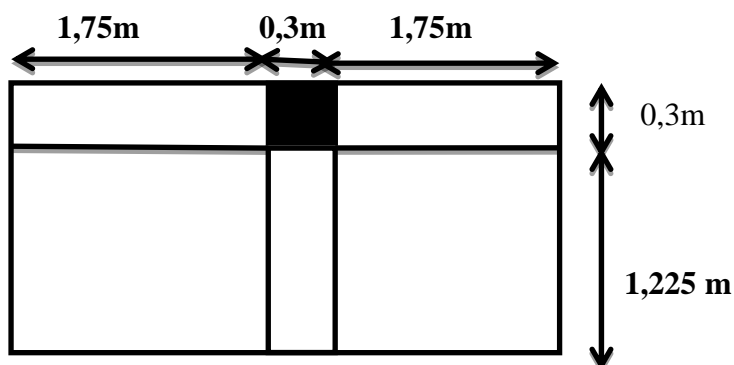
Dimension de la section revenant au poteau (H-2).
